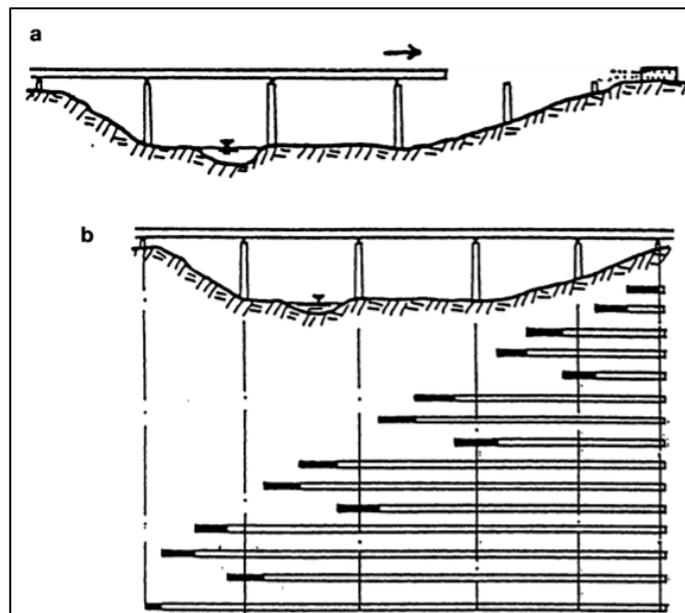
Puente sobre el valle del rio Werra. a) lanzamiento de la estructura metálica b) fases de hormigonado [3]
